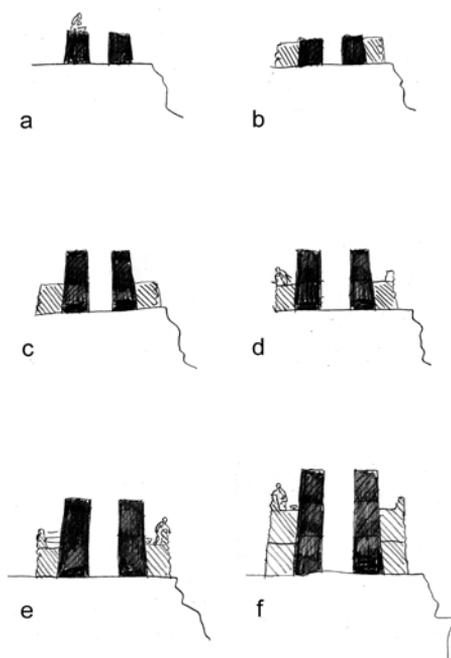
Propuesta del sistema constructivo de la torre de Vallferosa en tongadas sincrónicas: esquema de construcción de la torre en dos tongadas sincrónicas, a) construcción de la anilla interior; b) construcción de la anilla exterior; c) nueva tongada de la anilla interior; d) nueva tongada de la anilla exterior; e) continuación de la anilla interior; f) continuación de la anilla exterior.
